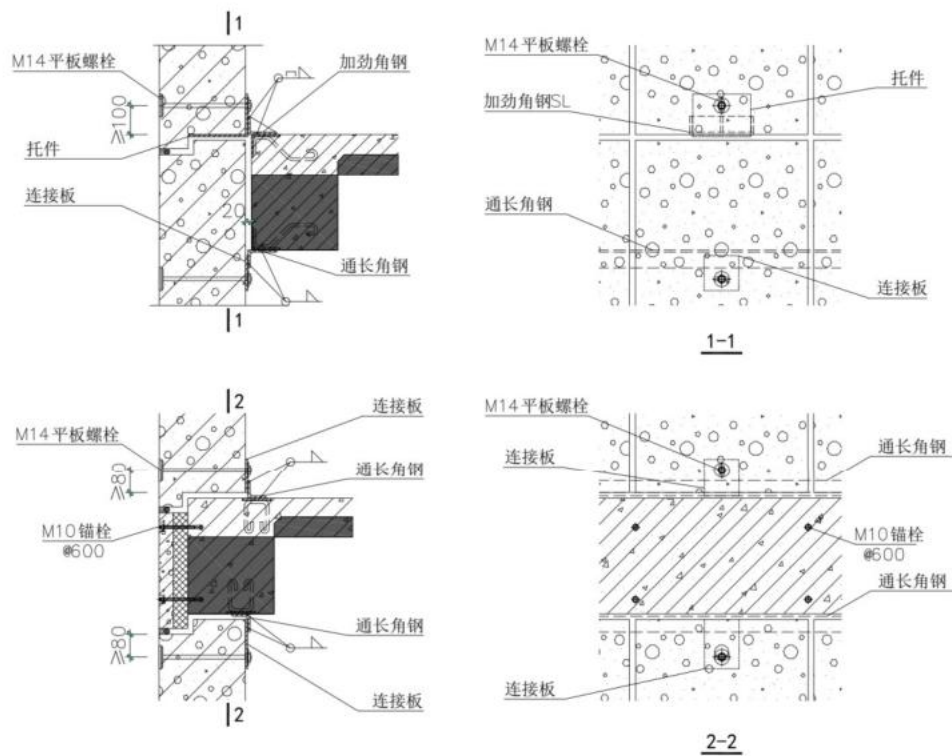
钢筋混凝土结构外墙墙板平板螺栓节点
